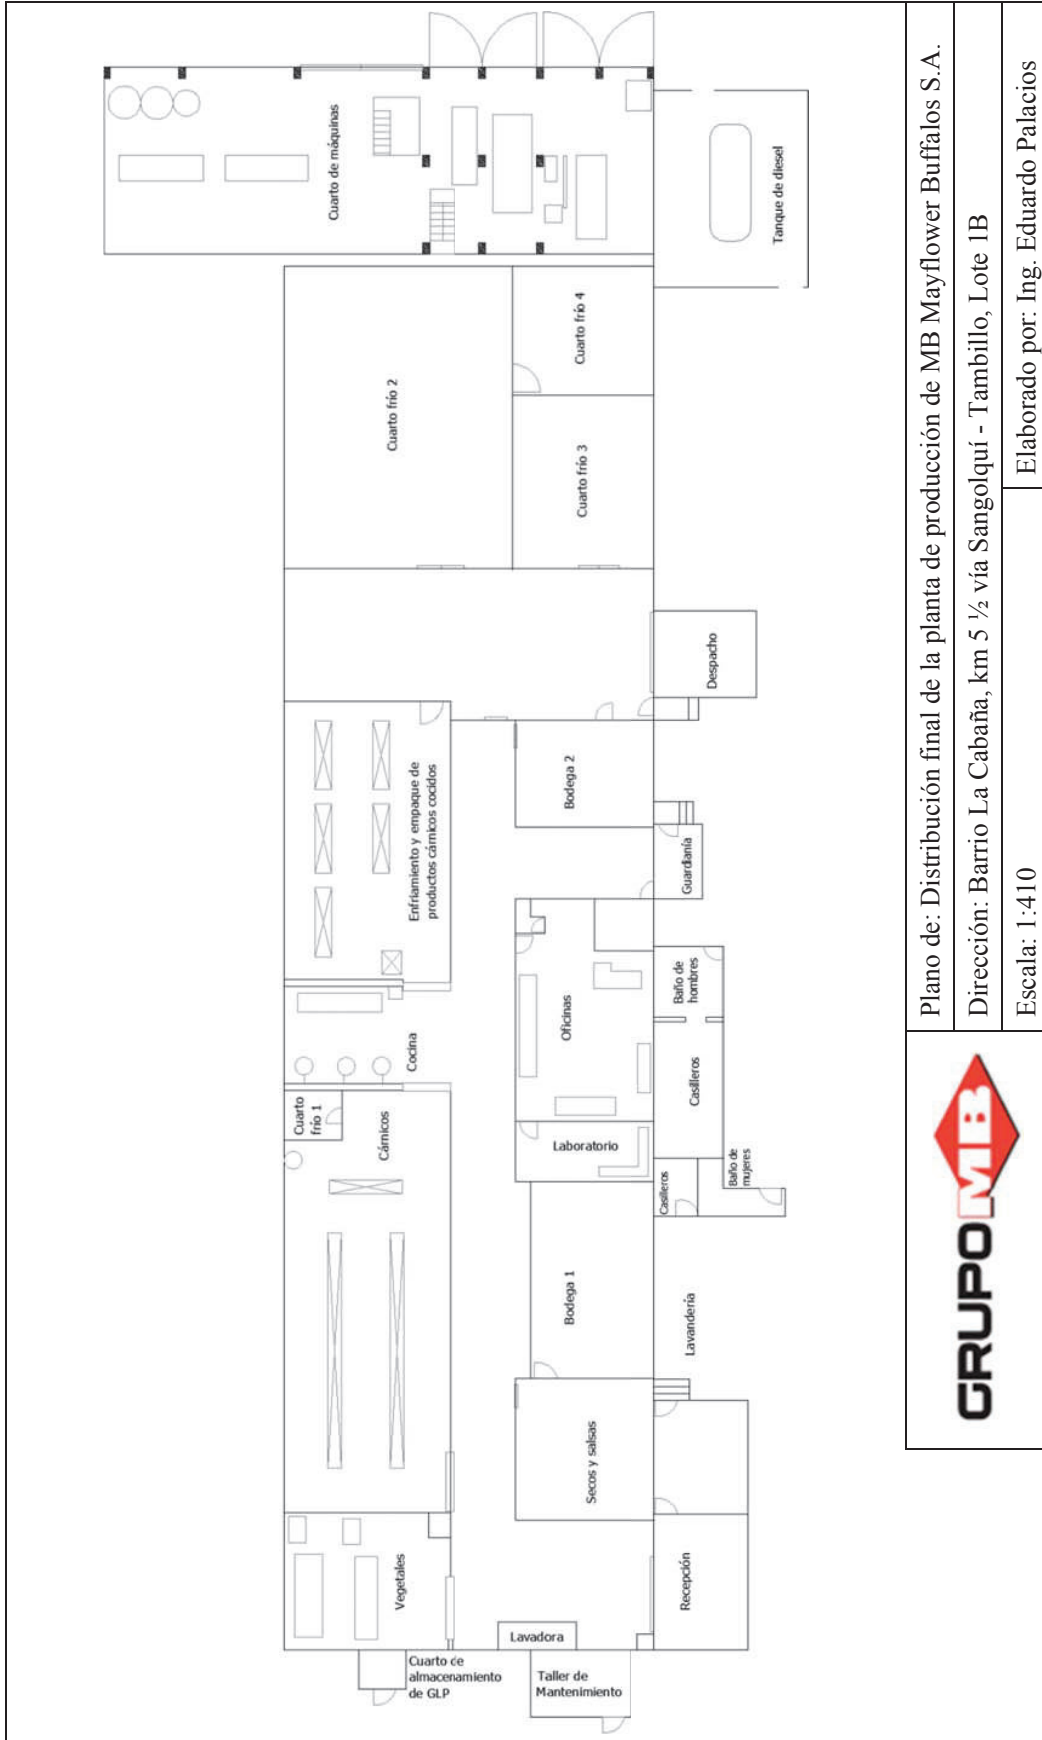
Layout inicial de la planta de producción, escala 1:410
